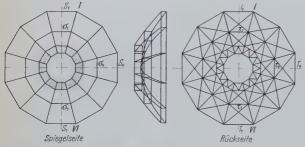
Systemaufbau des Spiegels (ohne Spieren)
